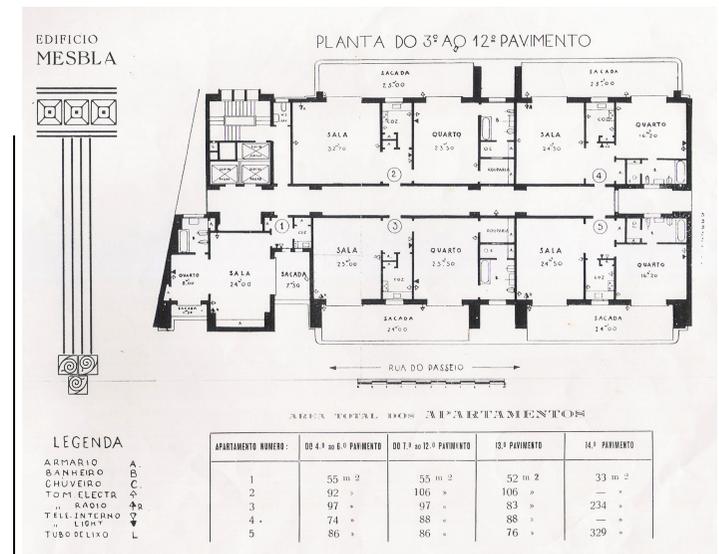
Foto da Planta tipo do edifício Residencial Mesbla.
